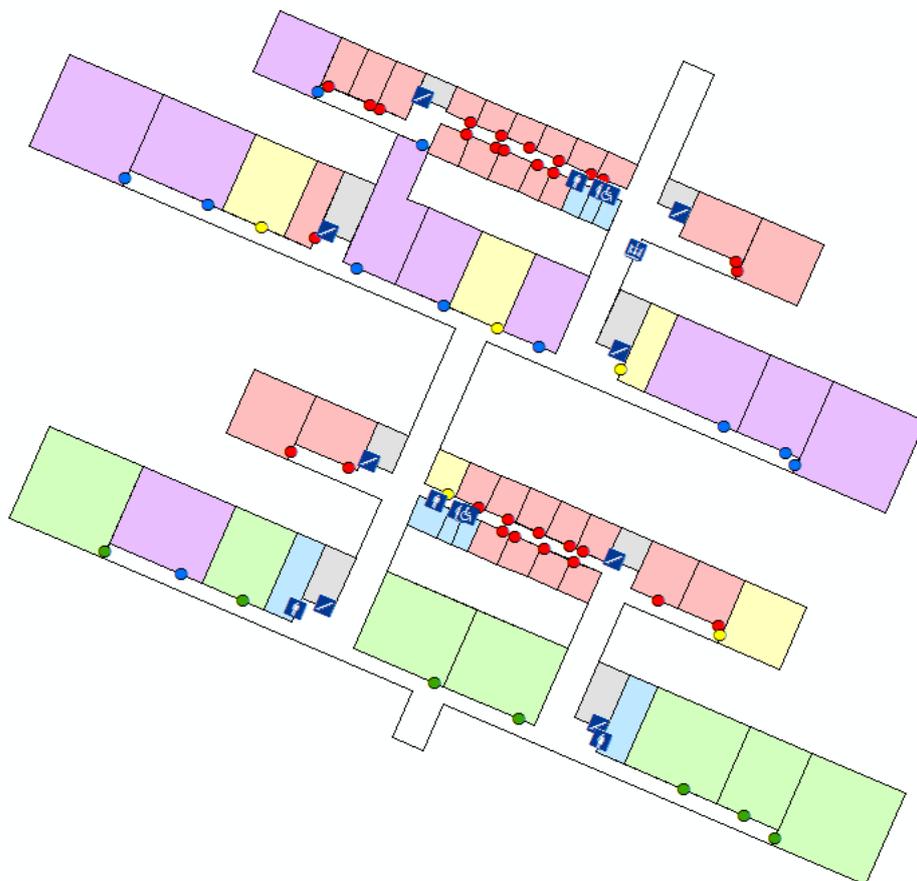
GERAÇÃO DA PLANTA BAIXA NO SOFTWARE ARCGIS
